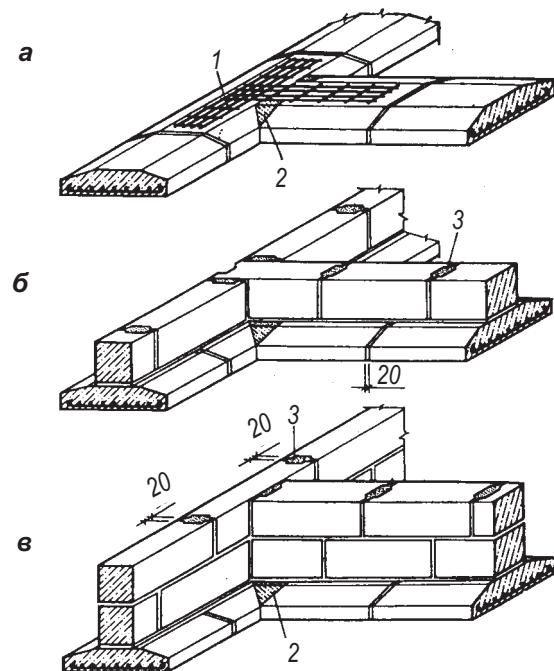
Сполучення фундаментів поздовжніх і поперечних стін:
